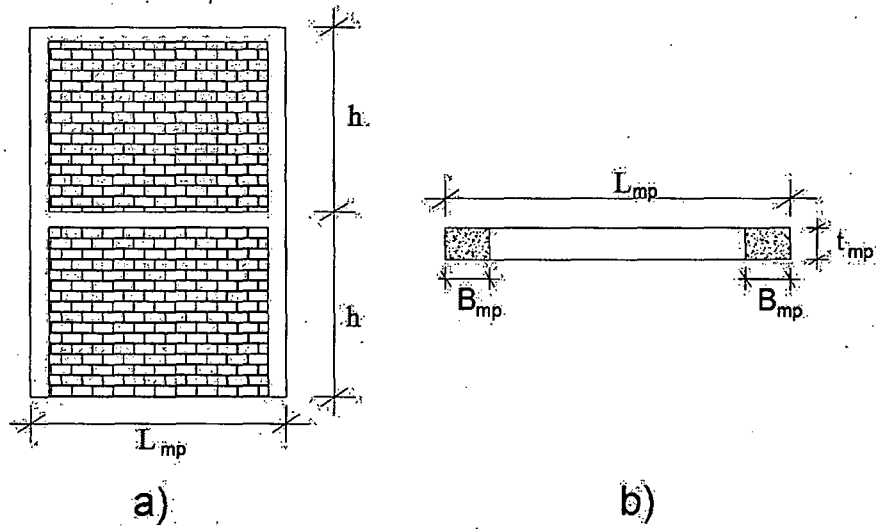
Muro patrón. a) Elevación; b) Sección transversal.
